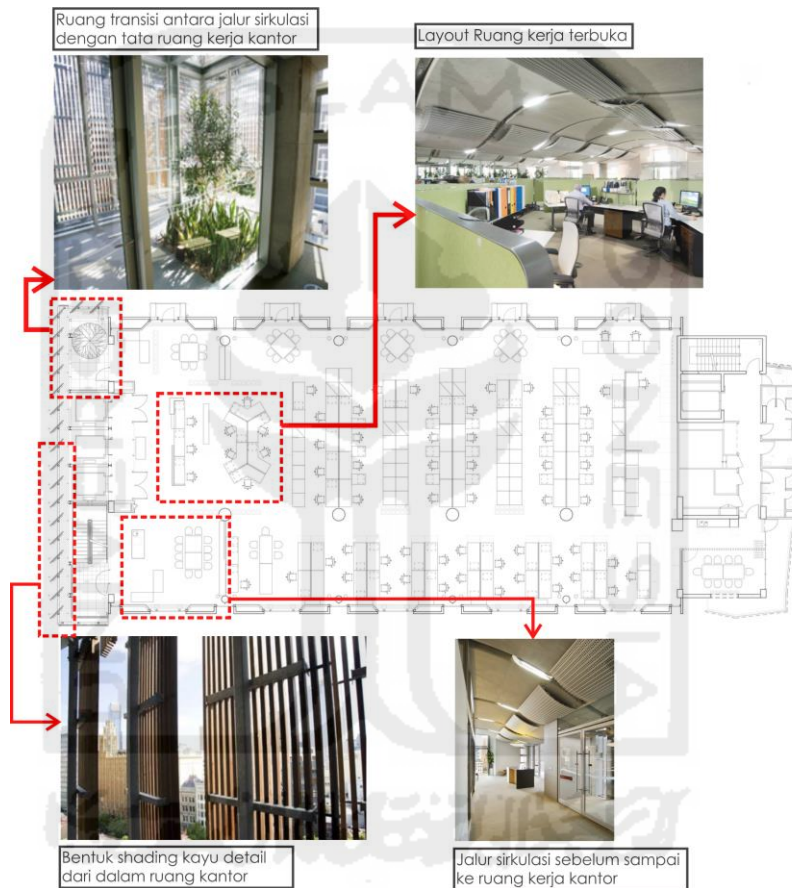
Re-Draw tampilan ruang dalam bangunan
